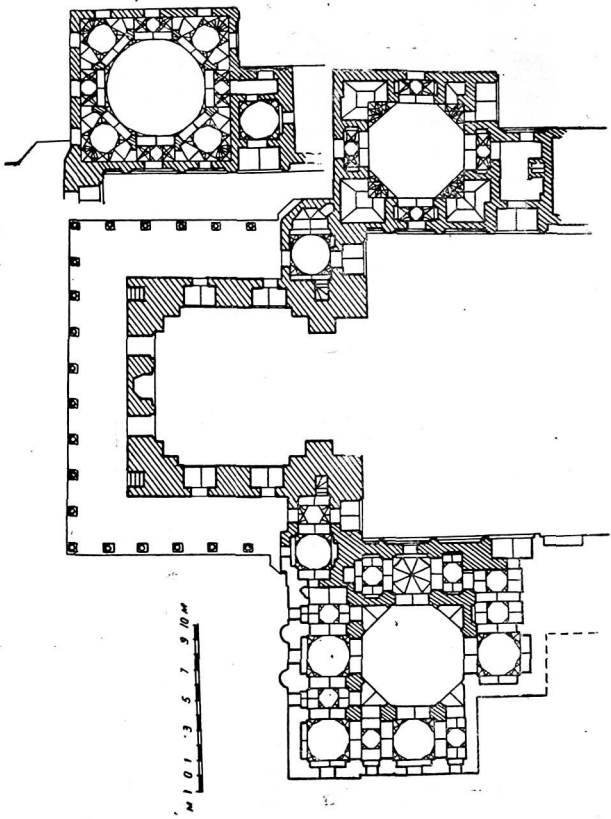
Мечеть Анау. План 1-го этажа и второго этажа восточной ларханы (в правом верхнем углу) с показанием проекций перекрытий.
